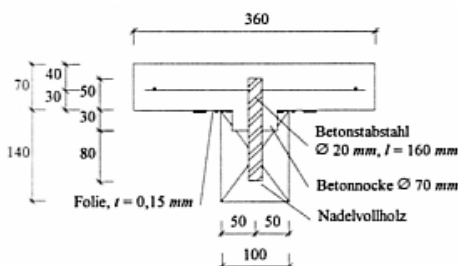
Querschnitt einer Betonnocke mit Baustahl [45]
